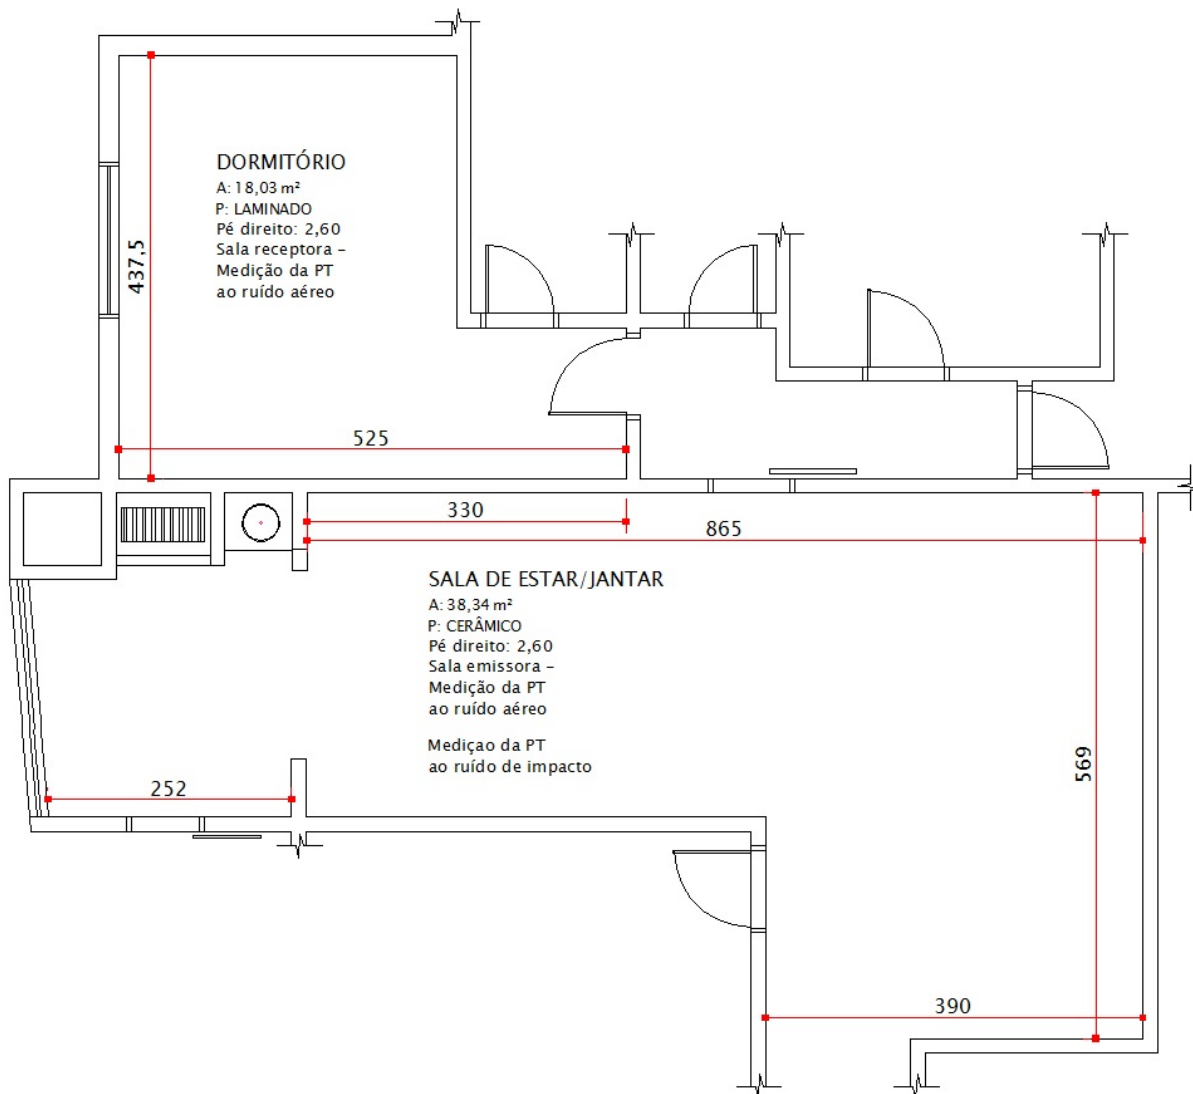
Planta baixa - pavimento tipo - 16-R8-N-BCO-PC
